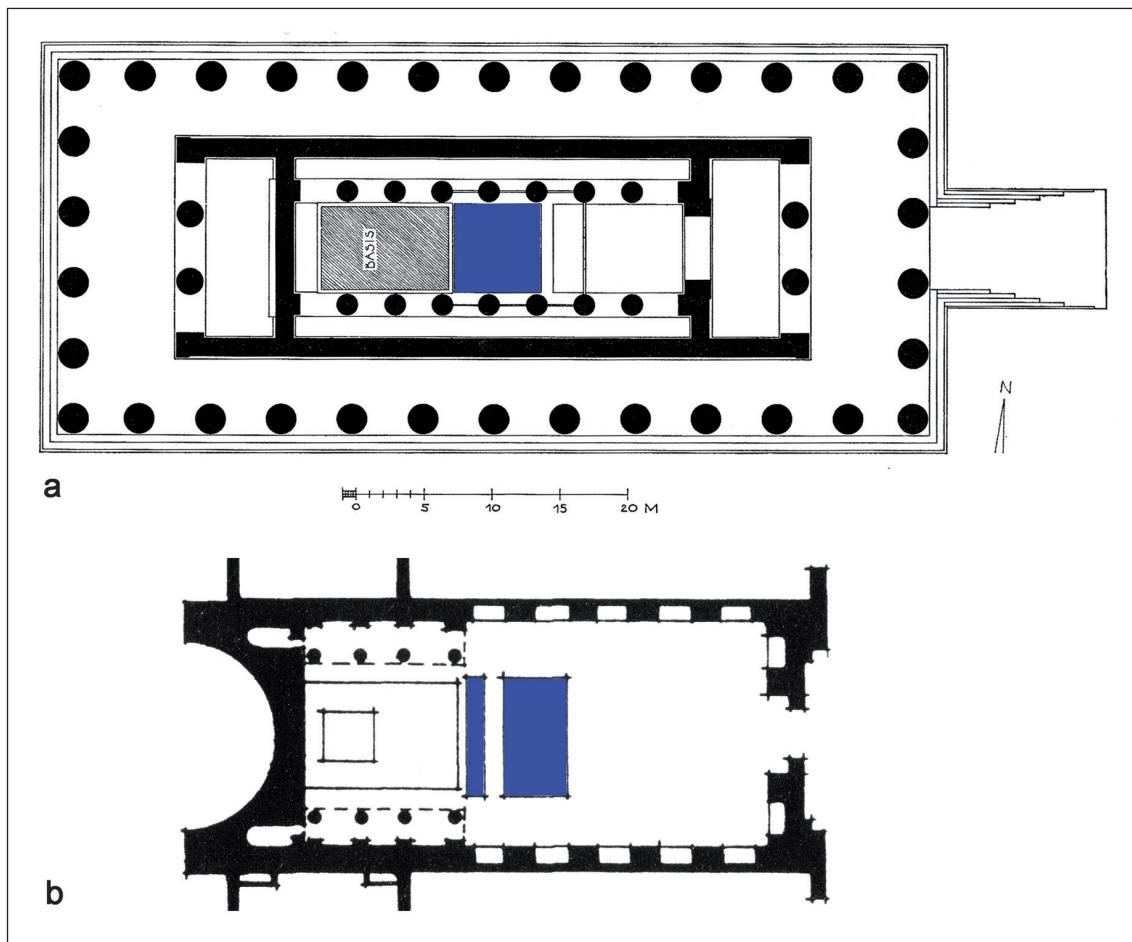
a. Olympia, Zeustempel, Grundriss mit Becken (blau). – b. Pergamon, Rote Halle, Grundriss mit Wasserbecken (blau).
